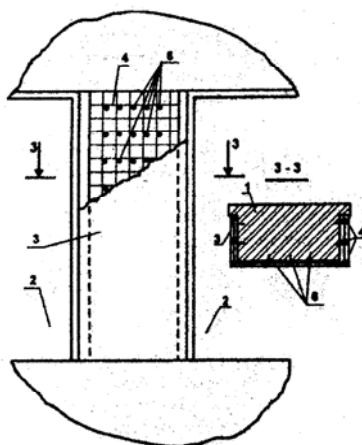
Штукатурная (железобетонная) рубашка:
